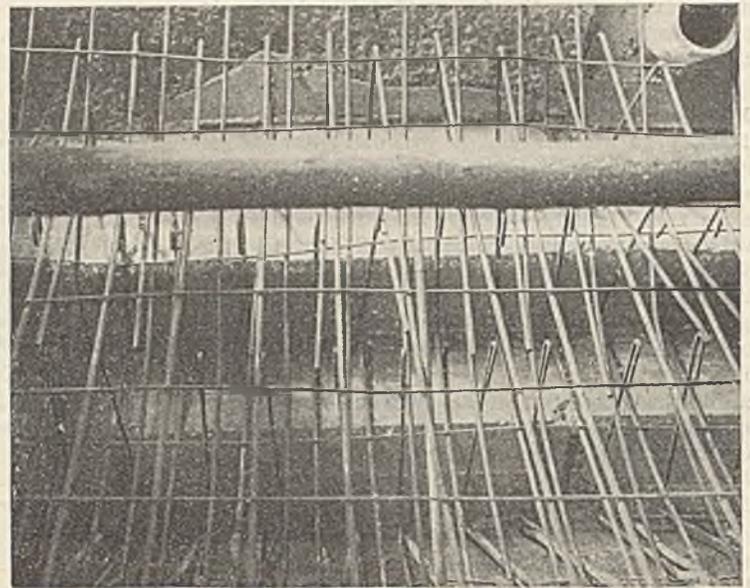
Viadukt Mirskofen. Fertige Pfeilerunterfangung mit Bewehrungsanschlüssen.
